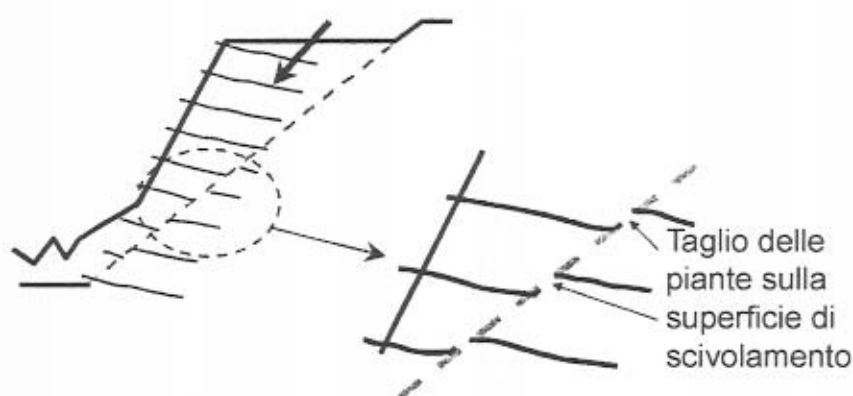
Instabilità di un pendio con rottura a taglio delle singole piante (SCHUPPENER, 2003)
